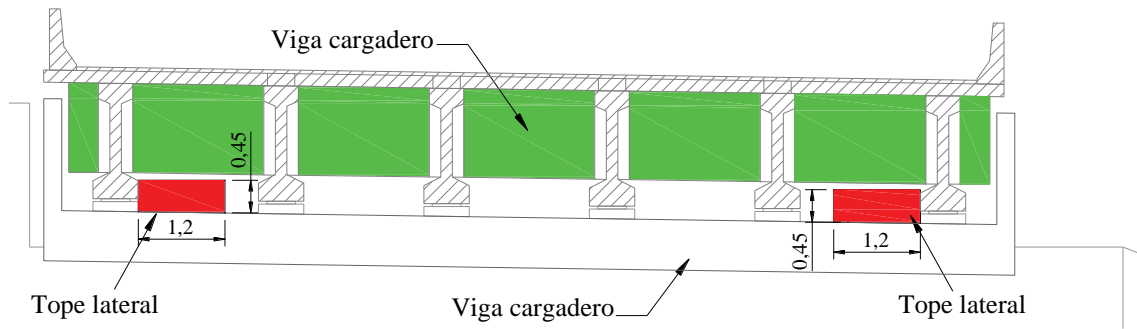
Vista esquemática de la sección transversal de la superestructura del puente de calle Paso en el apoyo del estribo.
